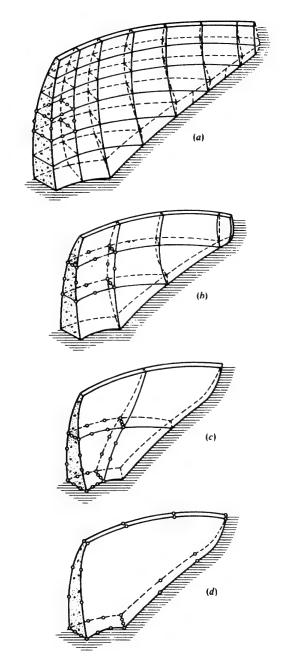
Presa bóveda en valle rígido - diferentes subdivisiones en elementos.
